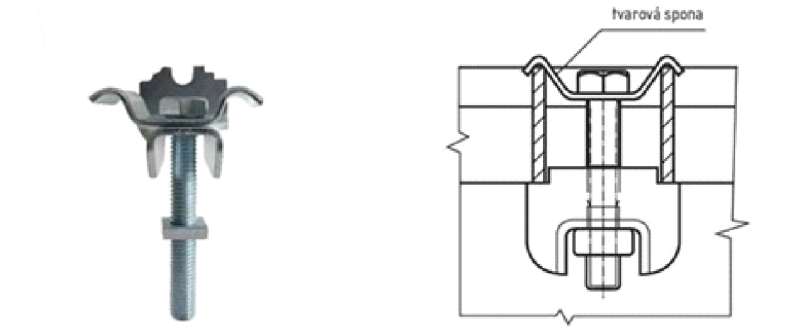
DETAIL UCHYCENÍ KOMPOZITNÍHO ROŠTU
